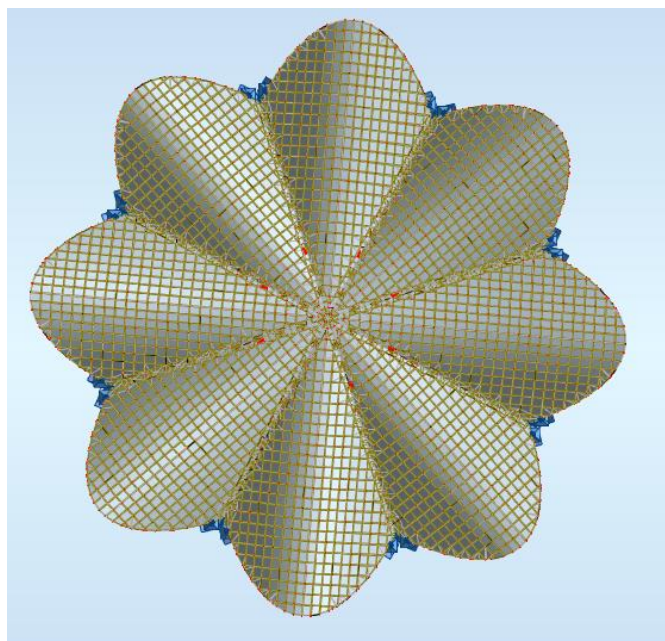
Colocação de armaduras sob a cofragem reta de madeira no restaurante Los Manantiales [54].
